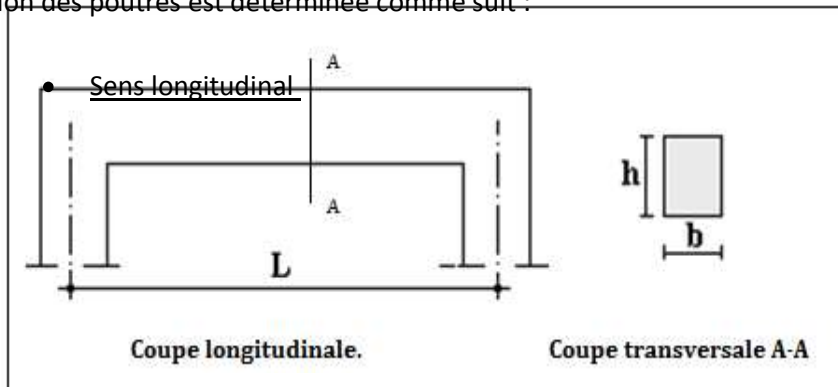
coupe longitudinale et transversale d'une poutre
